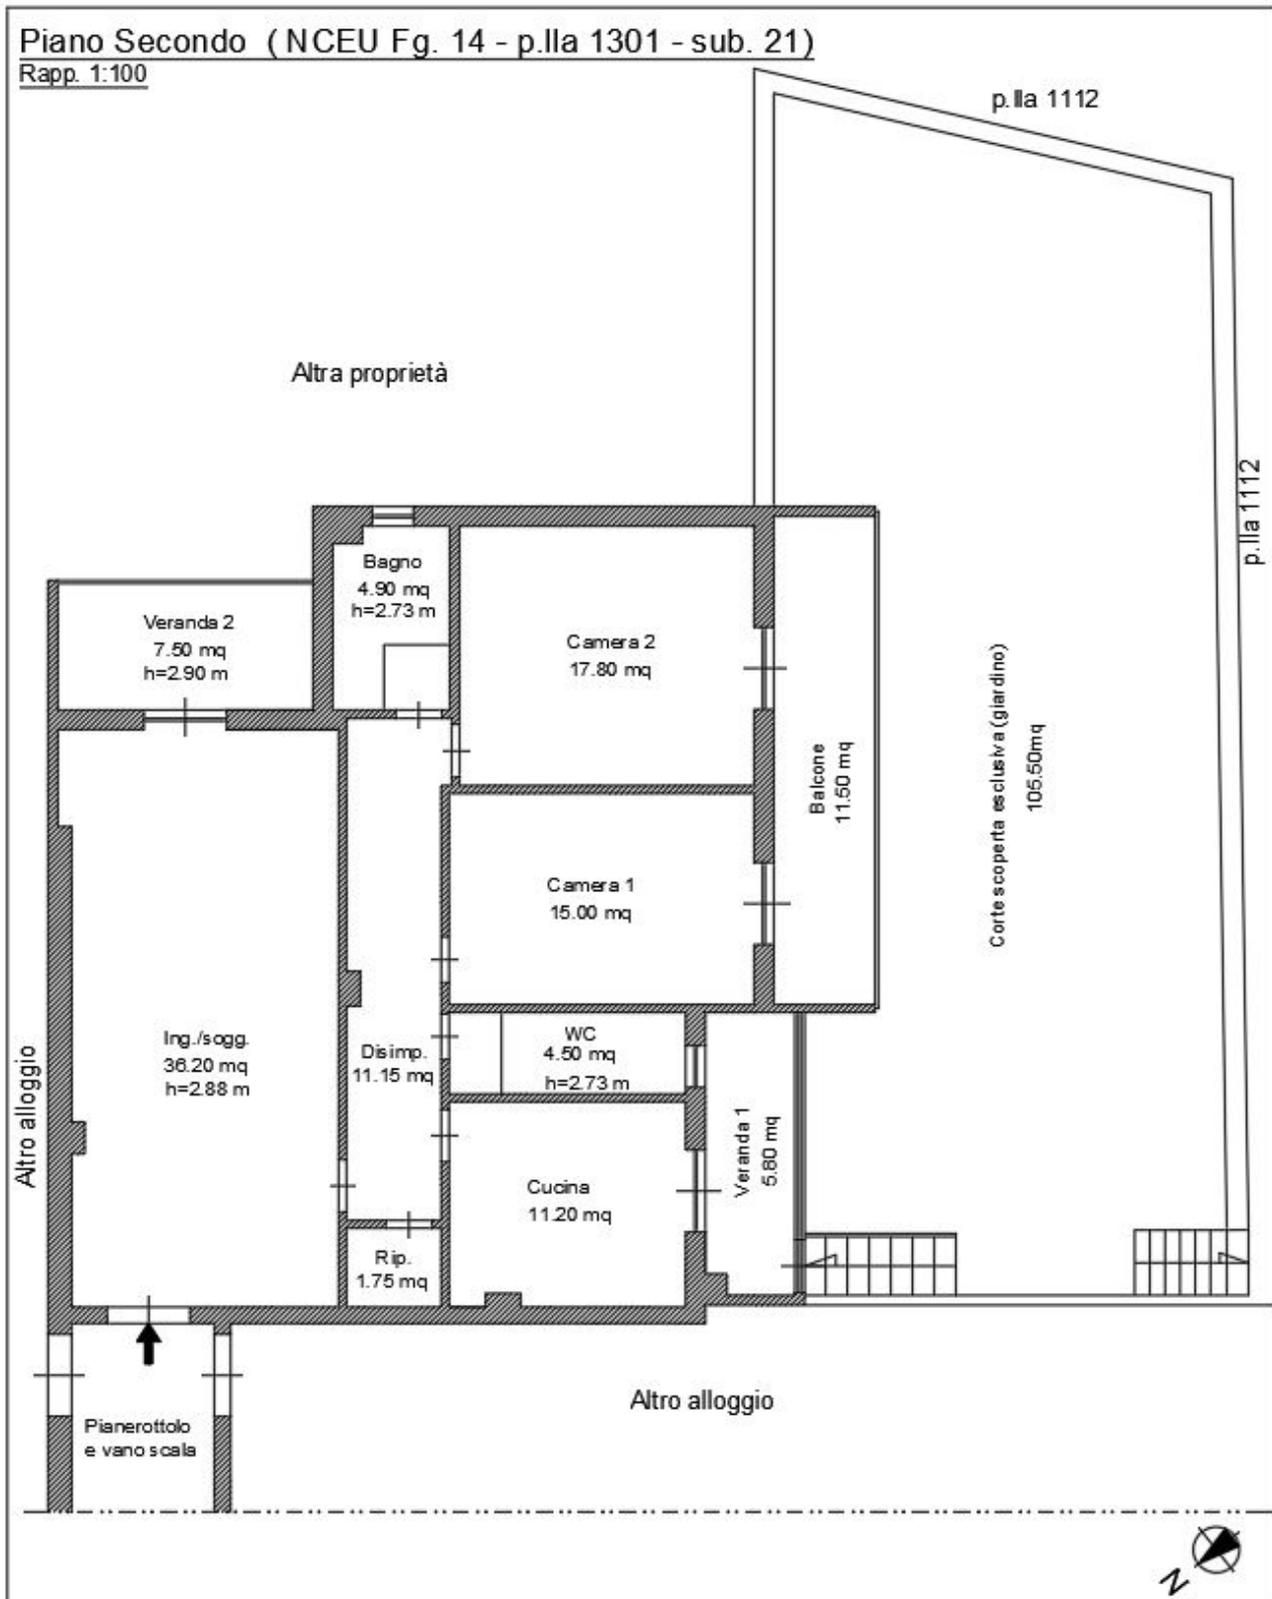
Pianta dell'abitazione pignorata – piano secondo (Fig. 14, p.lla 1301, sub. 21)
